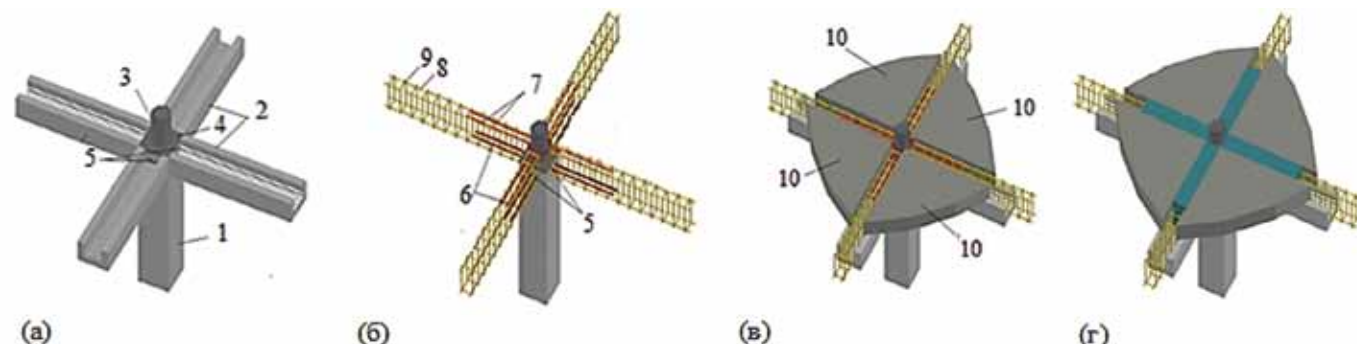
Общий вид узла соединения сборно-монолитного железобетонного каркаса: а) 1 – колонна, 2 – деревянная опалубка перекрытий, 3 – цилиндрическое винтовое соединение, 4 – закладные детали; б) арматура сетки с продольной и поперечной арматурой стержней; в) плита перекрытия после заливки бетона на деревянную опалубку
